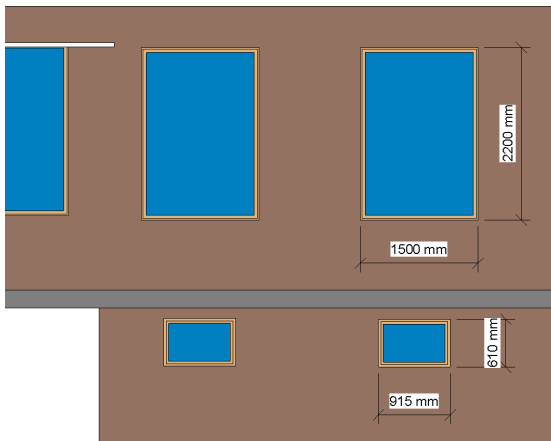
alzado de la fachada principal en el modelo de la ISPRS.
